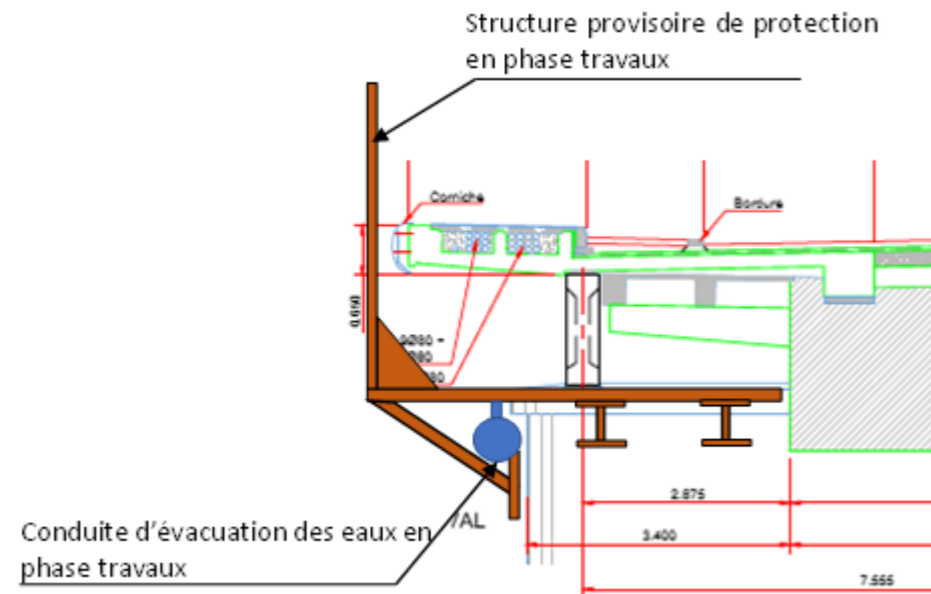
schéma de principe de la structure provisoire de protection sur le Pont Mozart
